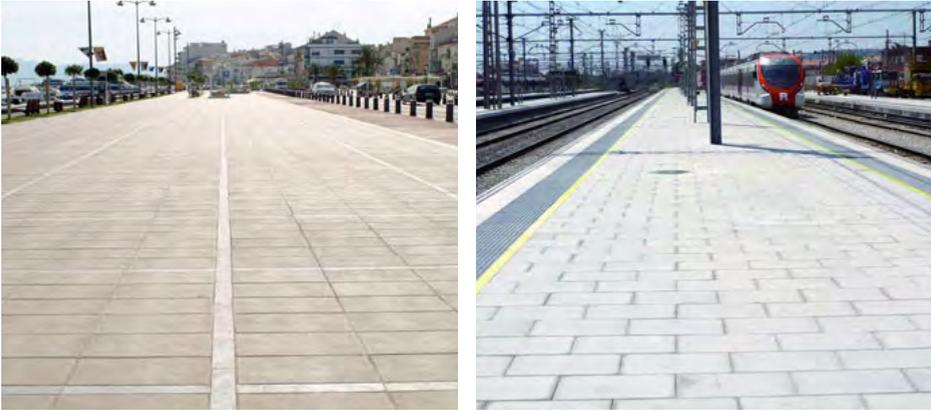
Pavimento terrazo liso. FIGURA 84: Pavimento terrazo granallado.
